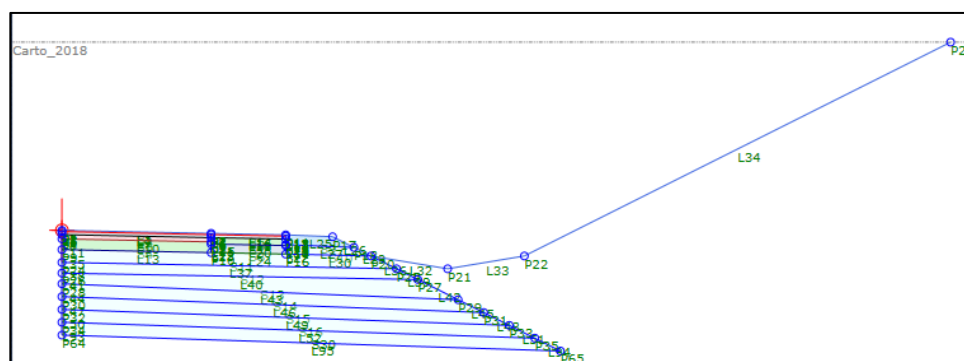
Subensamblaje sección transversal del proyecto (Fuente: Propia)
